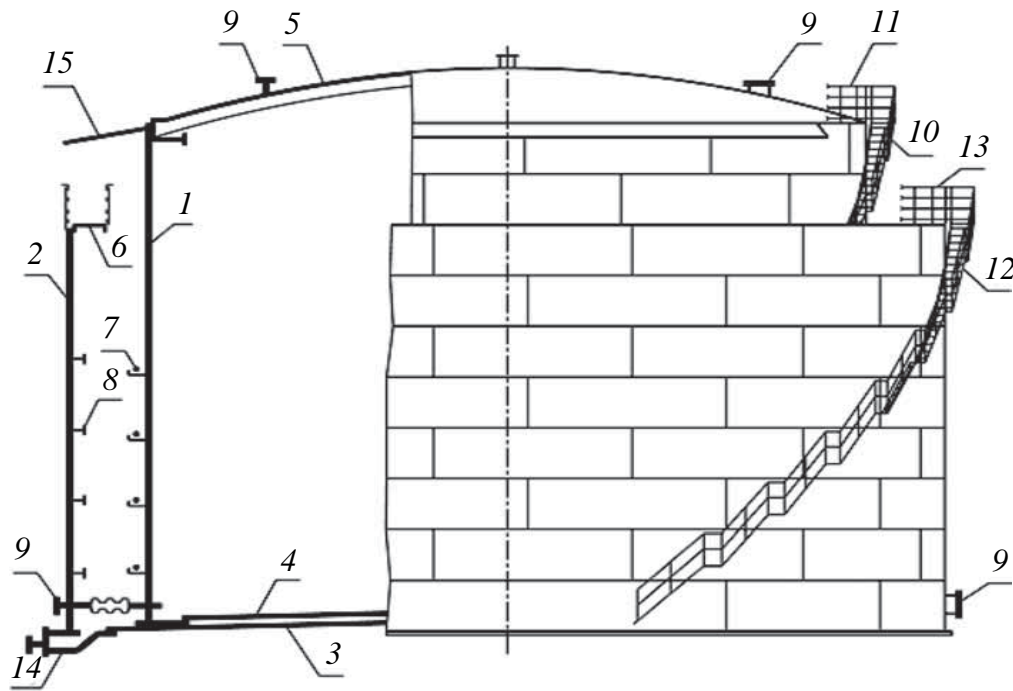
Общий вид резервуара с защитной стенкой:
